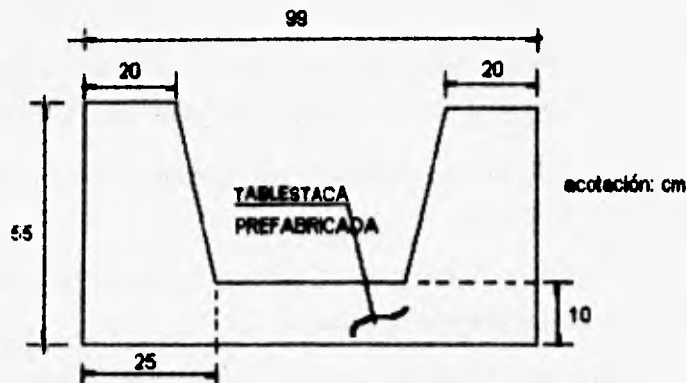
Dimensiones de las tablestacas prefabricadas.
